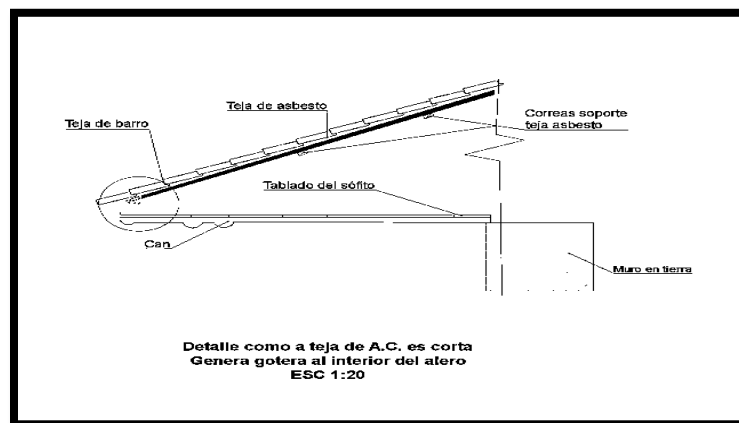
Detalle de la cubierta de Santa Barbara, en teja de barro sobre teja de fibro-cemento
